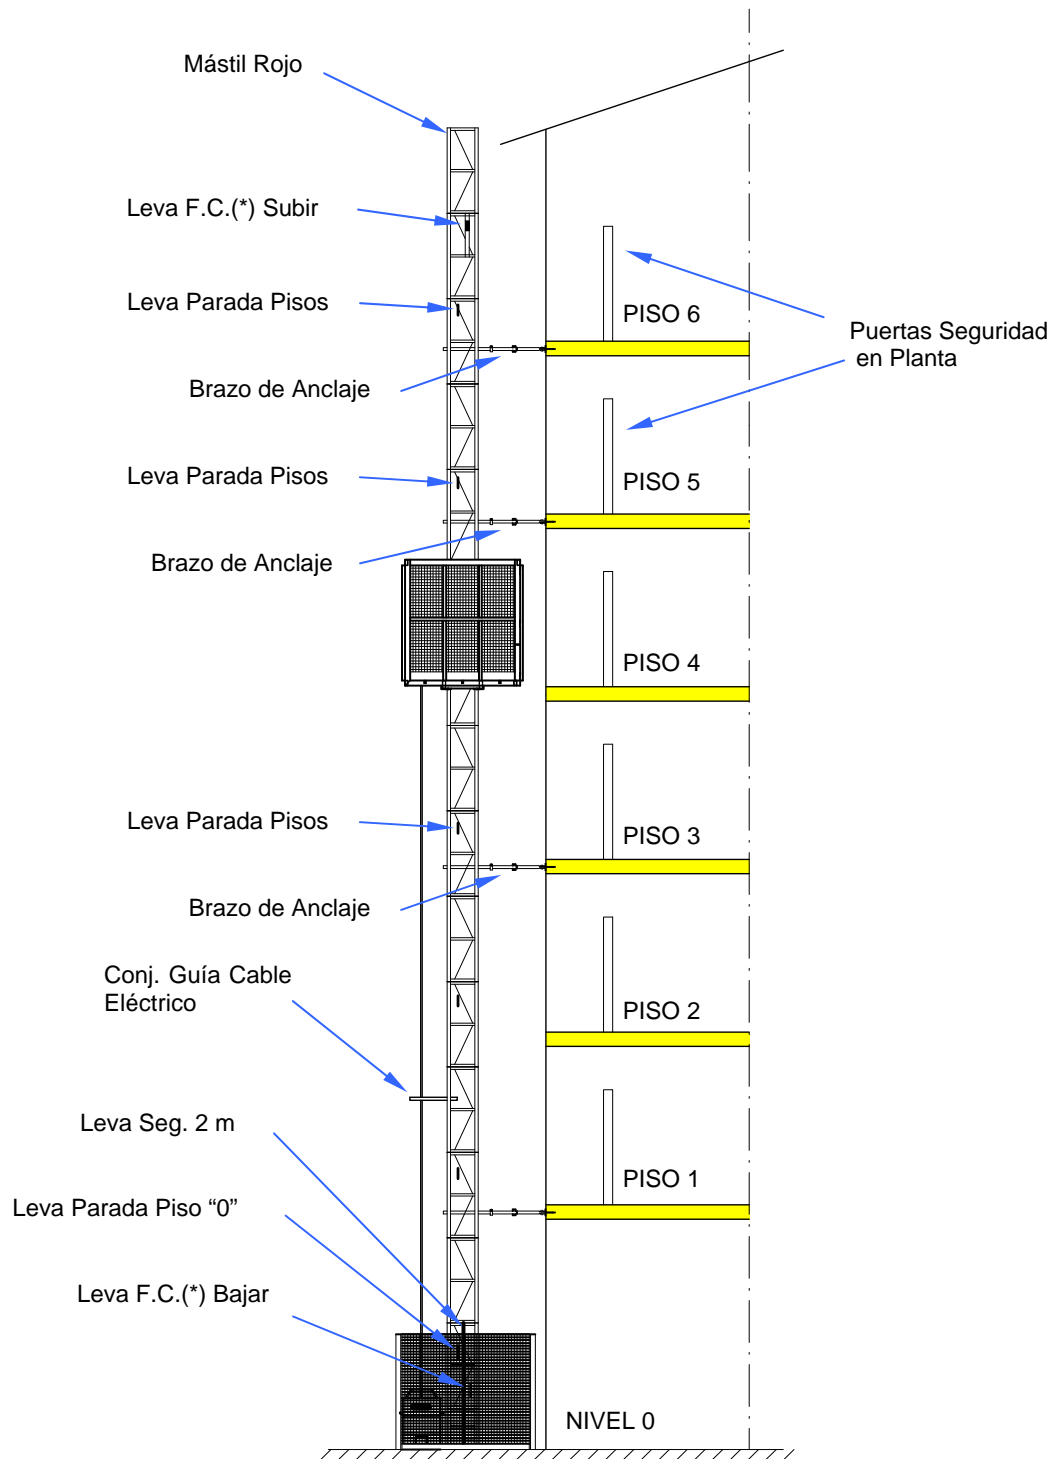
Leva de Parada de Planta y Leva F. C. Subir/Bajar
